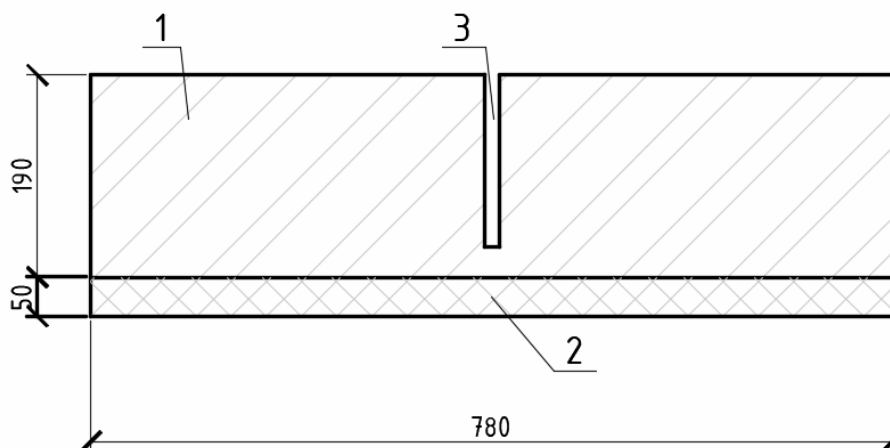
Схема сечения стены по кладке с 50 мм утеплителя с дефектом.
